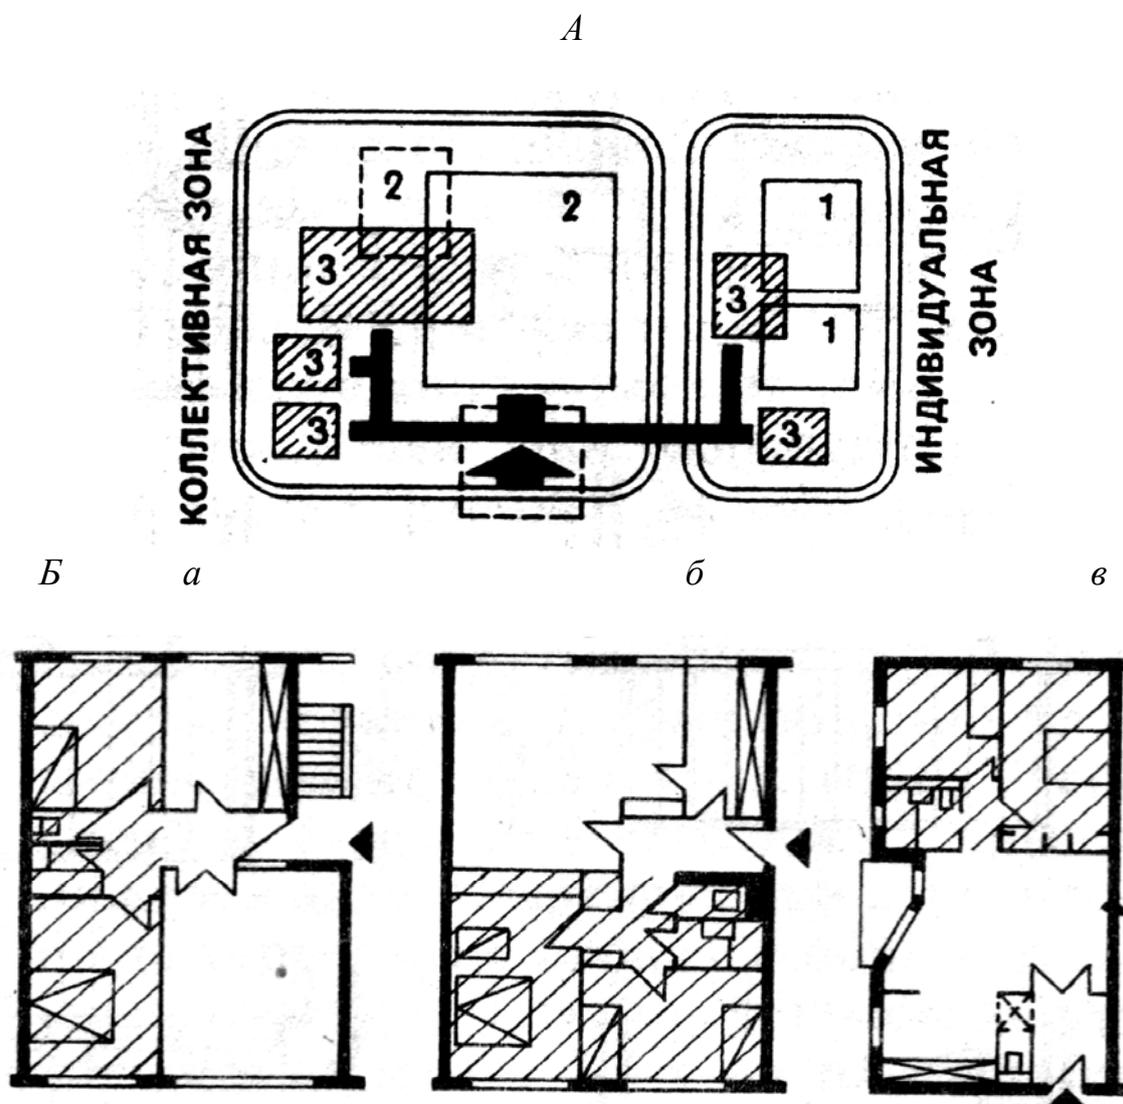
Схема зонирования квартиры с разделением ее на коллективную и индивидуальную зоны (А) 1 – спальня и личные жилые комнаты; 2 – комната общесемейного отдыха, столовая; 3 – подсобные помещения (кухня, санузел, коридоры). Планировочные приемы квартир с зонированием на коллективную и индивидуальную зоны. (Б) а – индивидуальная зона в глубине квартиры — имеет связь с передней; б – индивидуальная зона по одну сторону входа в квартиру, коллективная – по другую; в – зонирование квартиры с проходом в индивидуальную зону через коллективную
